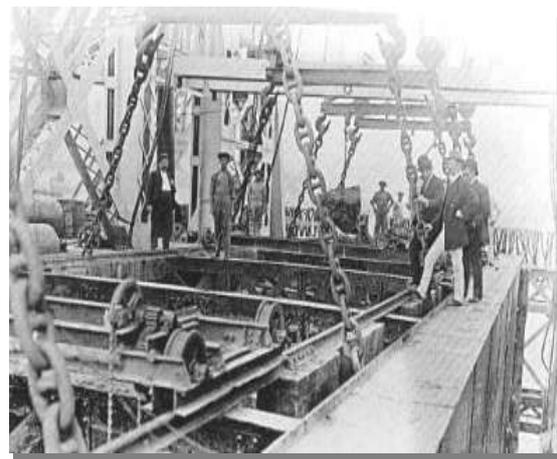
Detalhe da ensecadeira e sistema de transporte horizontal.
